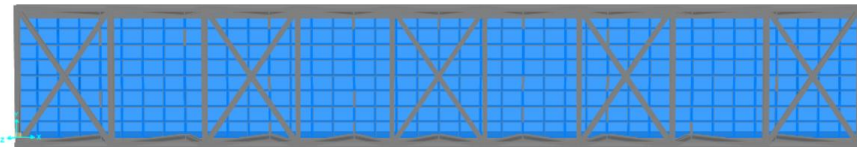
Planta pasarela tipo Warren. (Fuente: elaboración propia en SAP2000).
